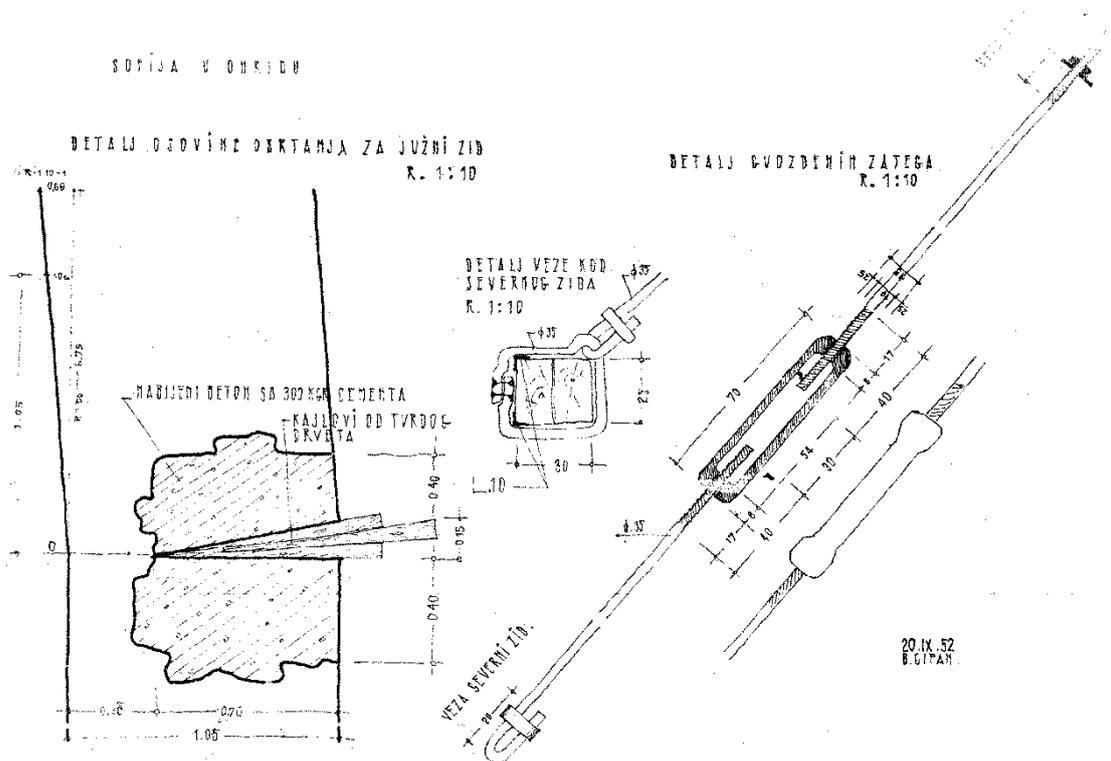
Detalles del sistema de rotación del muro sur: a la izquierda está representado en detalle el eje de rotación; a la derecha los tirantes y anillas; en el centro el anclaje del sistema en una viga doble da madera apoyada sobre el muro norte.
